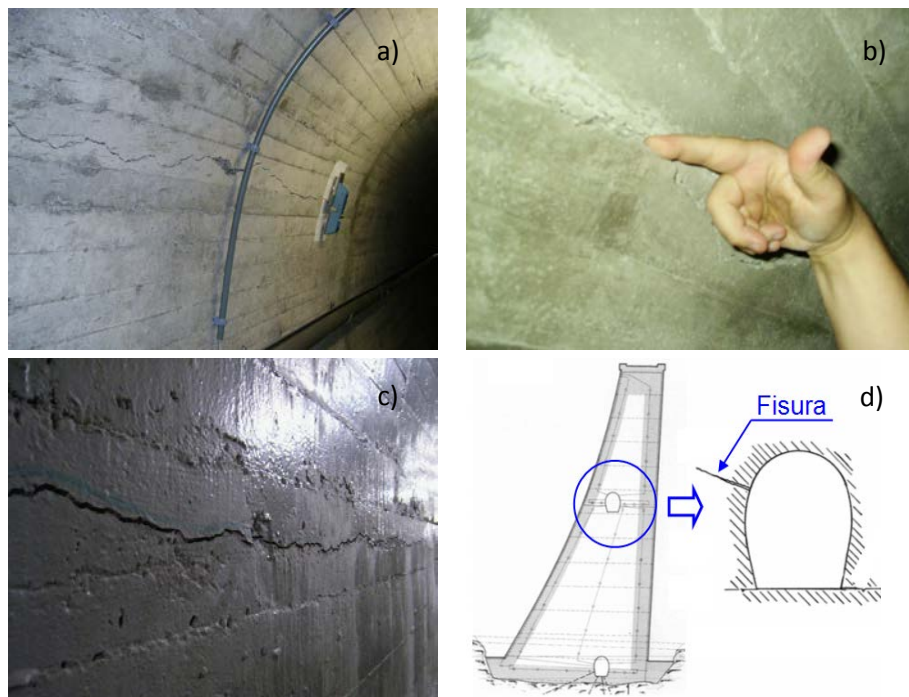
Fisura en el hastial aguas abajo en la presa de Isola (a), Rumedo (b), Portodemouros (c) y esquema de la fisuración en la galería (d) (Araújo, 2008).
